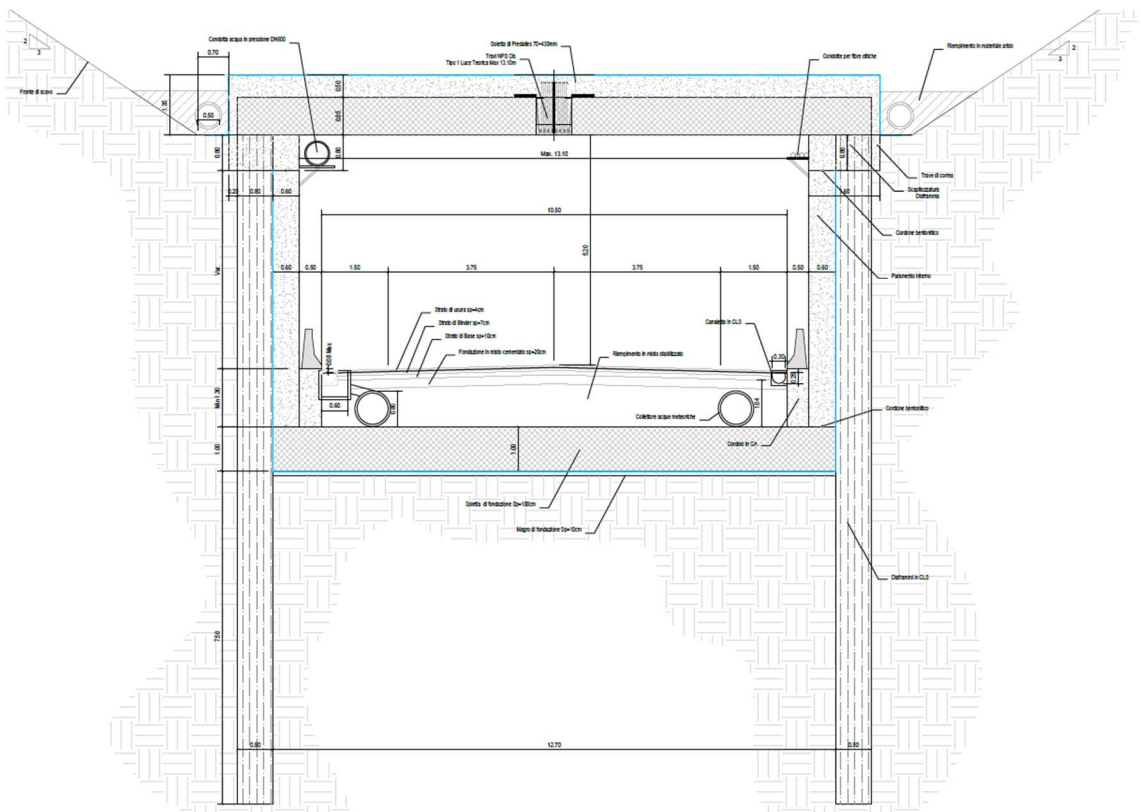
Scavo con diaframmi – sezione TIPO 1 (Galleria di linea)
